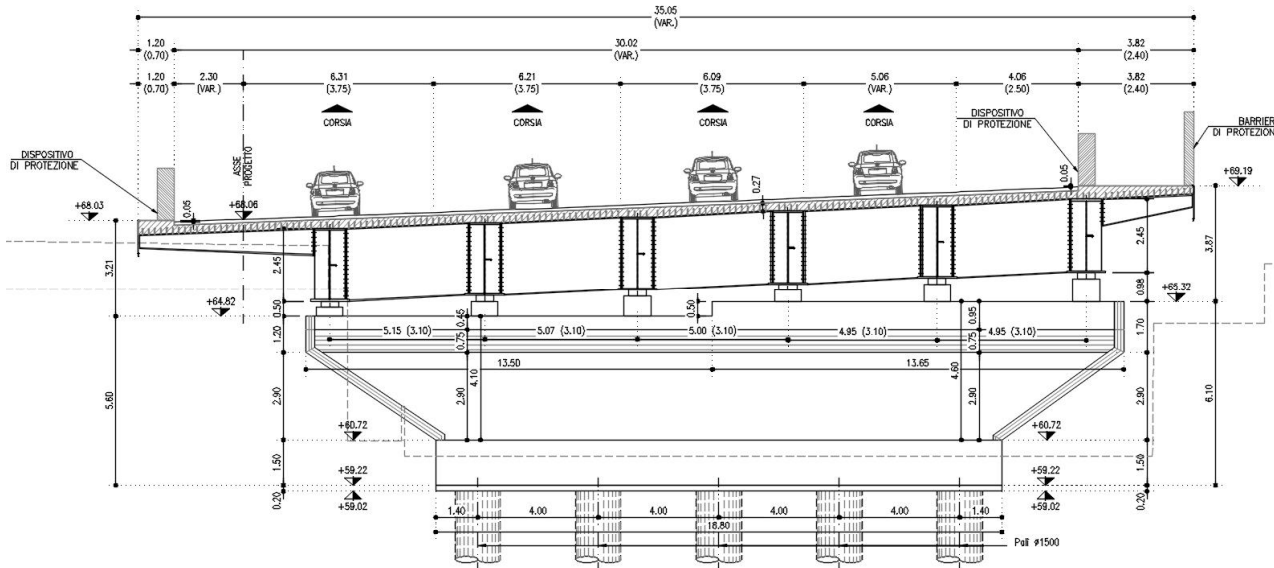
Pila a telaio - Sezione trasversale Pila P1
